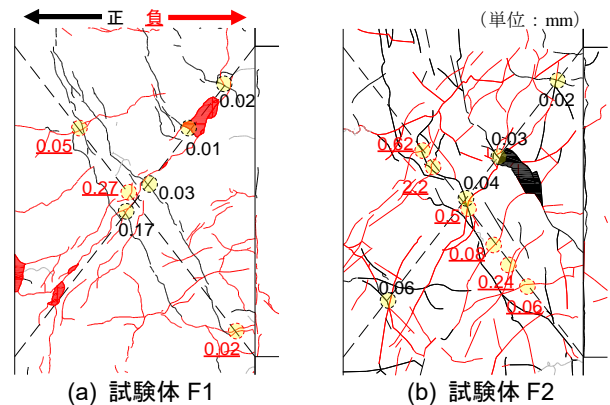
接合部のひび割れ発生状況 (R=1.5%载荷終了後の原点)
